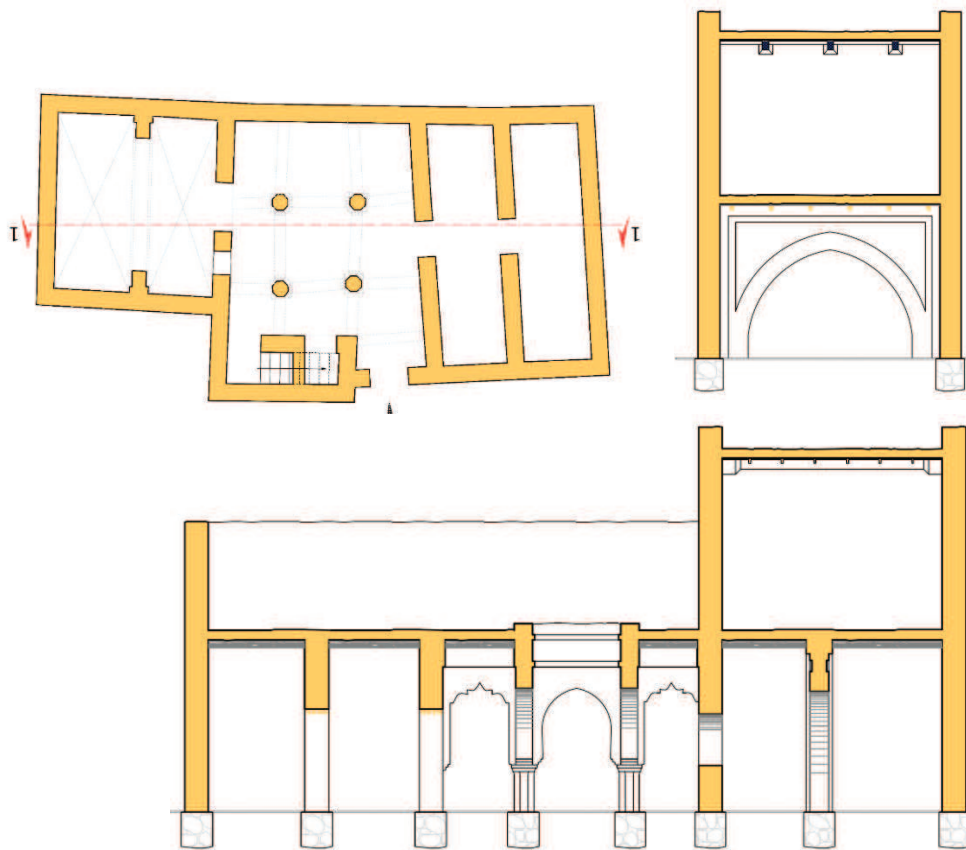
Vue en plan et coupe de dar Bouhjar, (échelle : 1/200).
